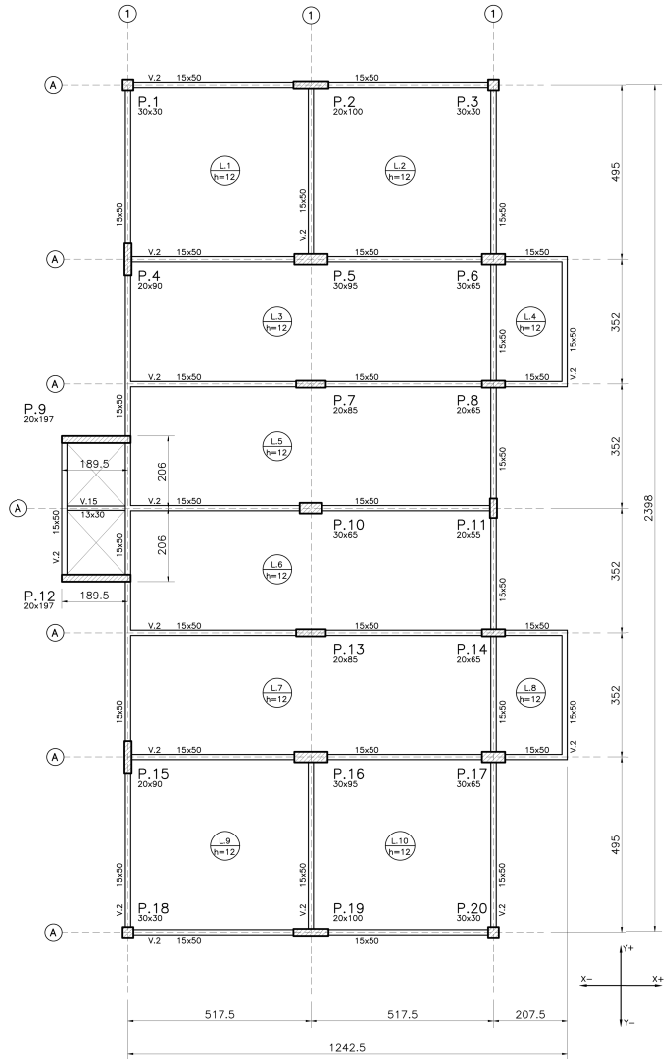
Forma do pavimento tipo da Estrutura 4.
